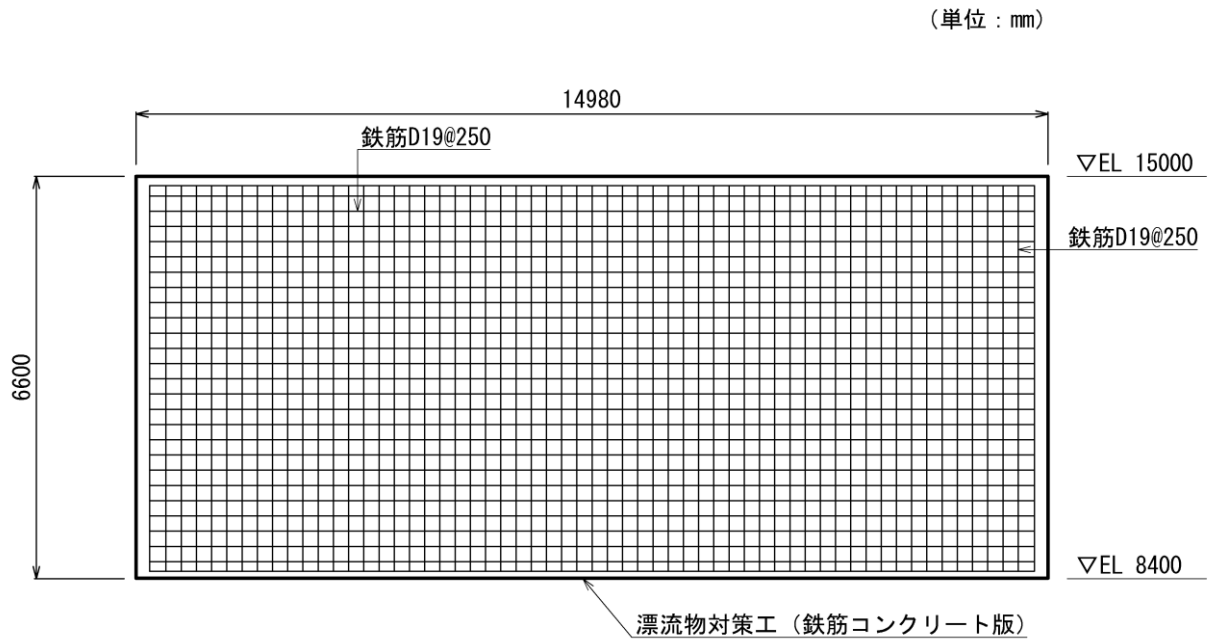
(1) 漂流物対策工 (鉄筋コンクリート版) の概略配筋図 (正面図)
